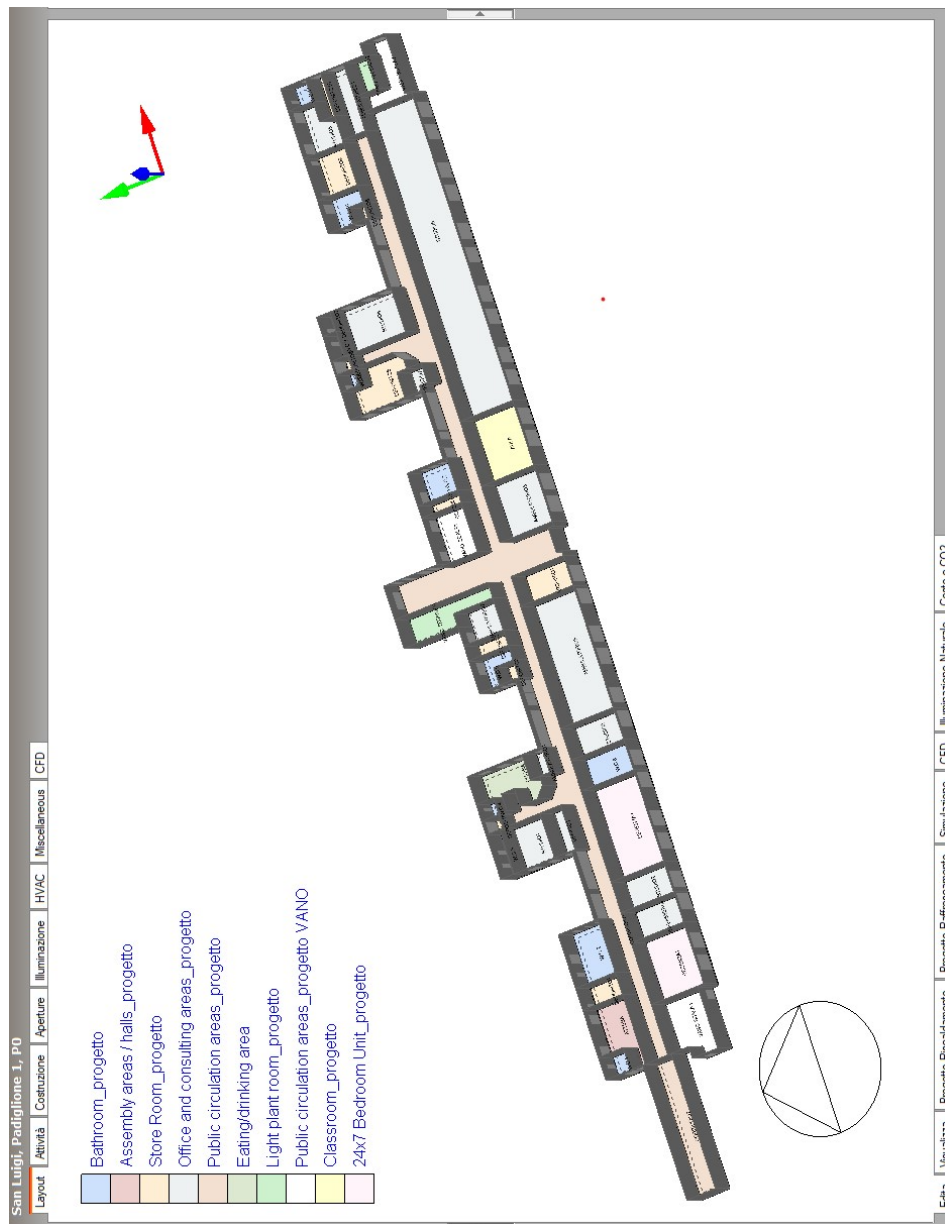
Zonizzazione con *DesignBuilder* del piano terra Padiglione 1 dell'ospedale San Luigi (TO).
